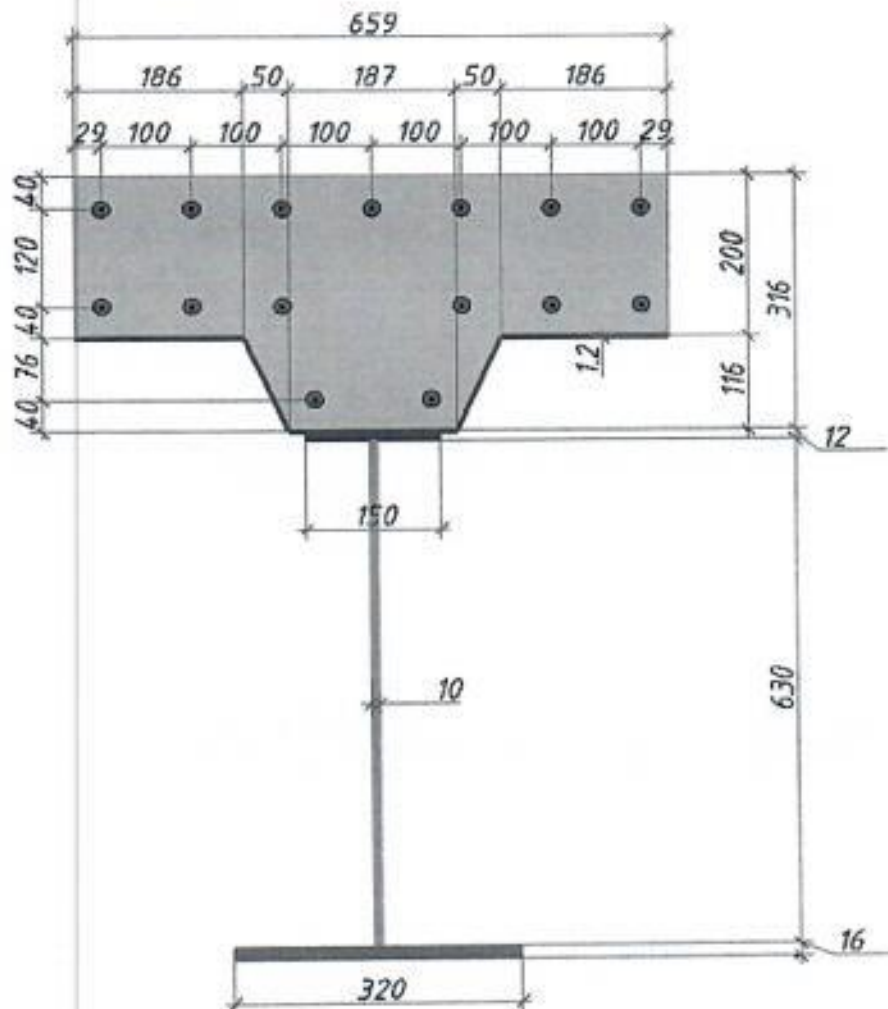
Поперечное сечение сталежелезобетонного перекрытия
